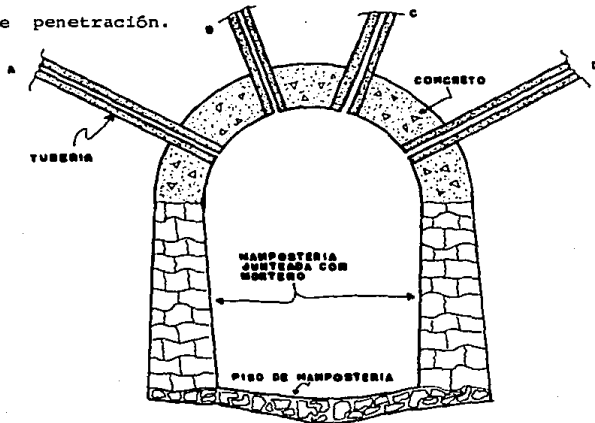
Sección transversal de la galería filtrante en el km 19 + 200 de la autopista Tijuana-Ensenada.
